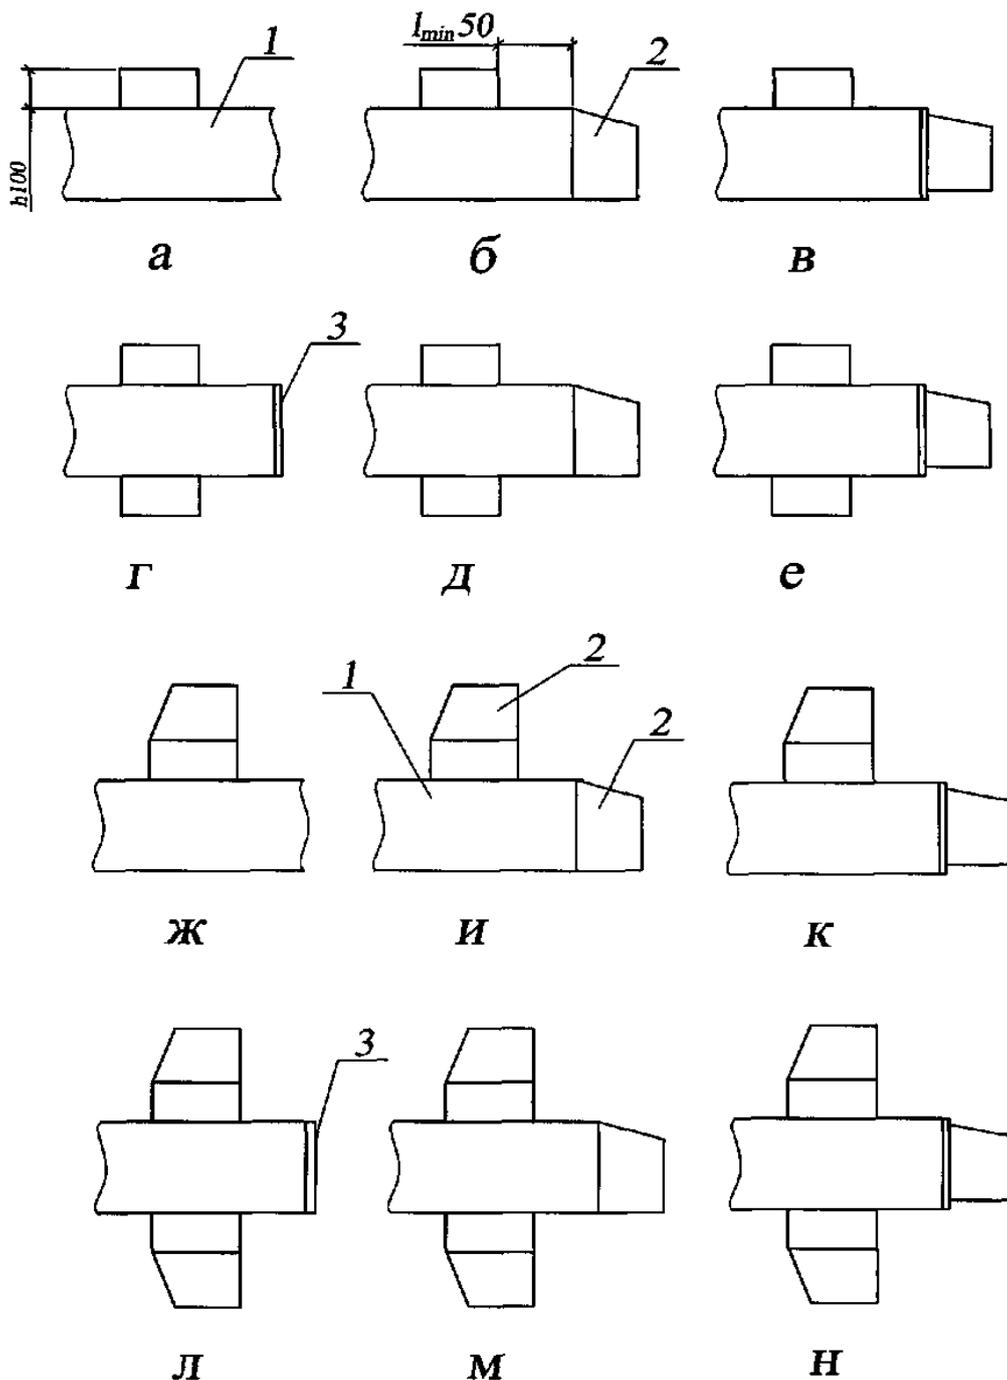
Схемы образования узлов ответвлений прямоугольного сечения:
